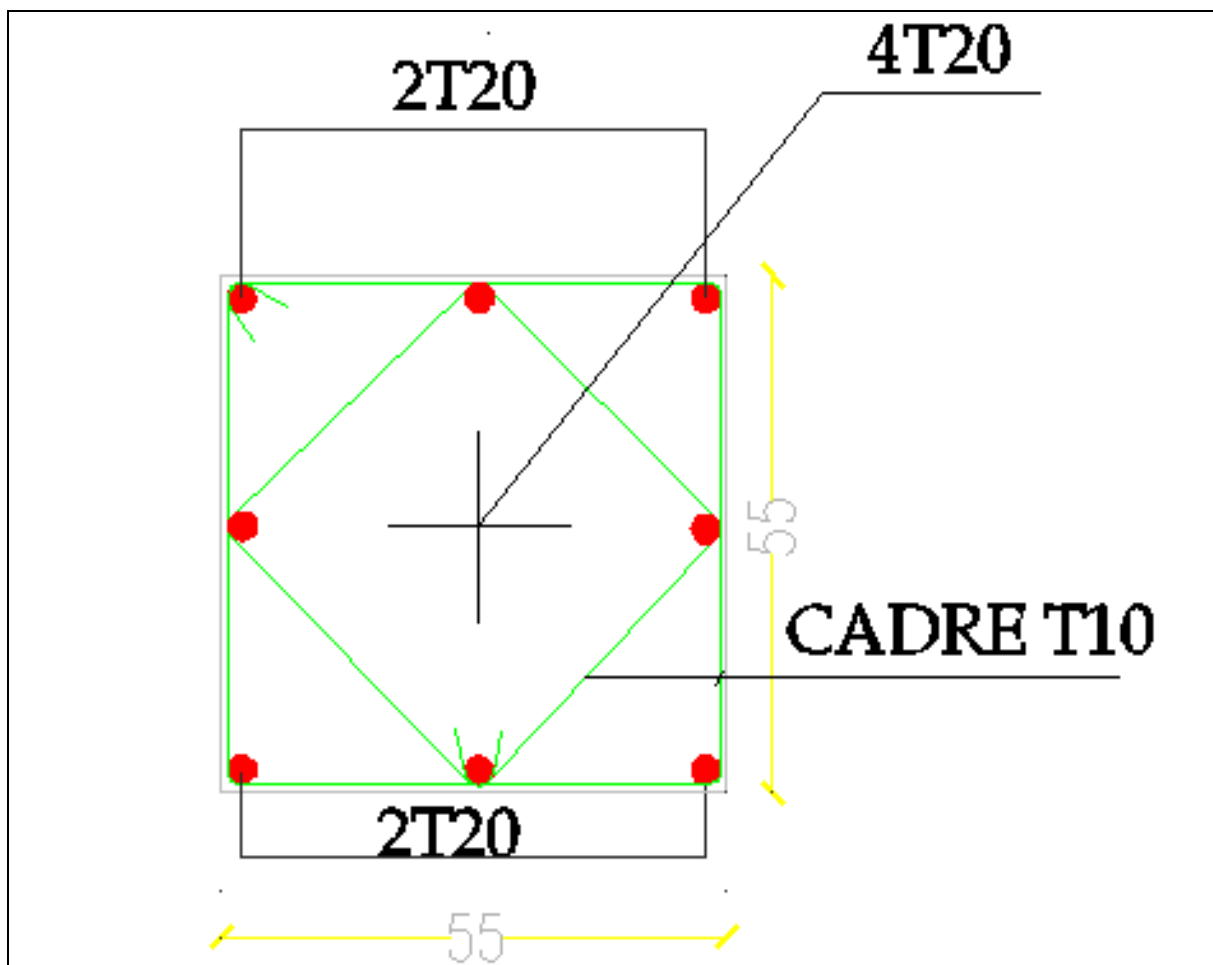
Ferrailage des poteaux carrés 55 x 55.
